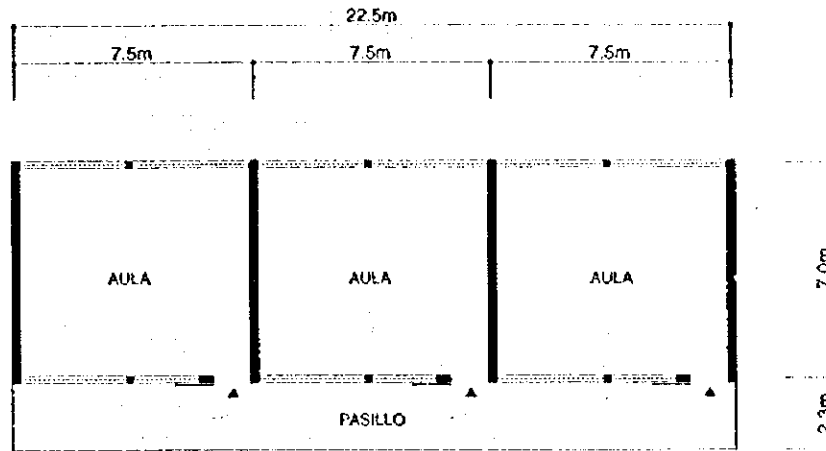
PLANTA GENERAL DEL TIPO 3 AULAS DE EDUCACION MEDIA
